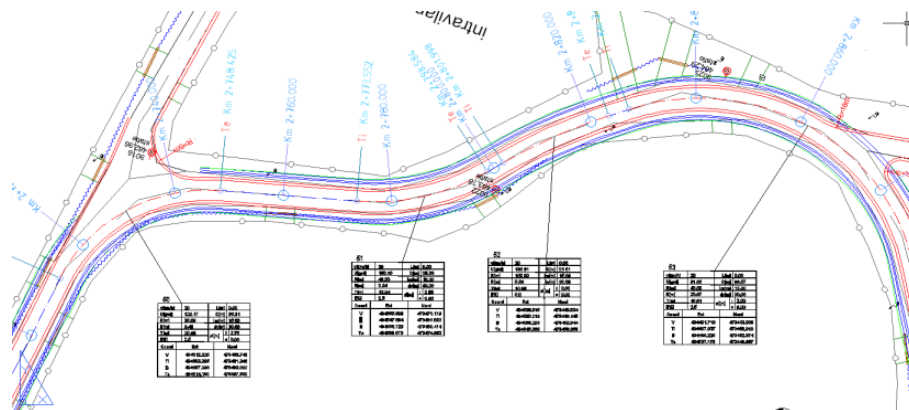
Geometrizarea axei în plan pentru ARD [4]
